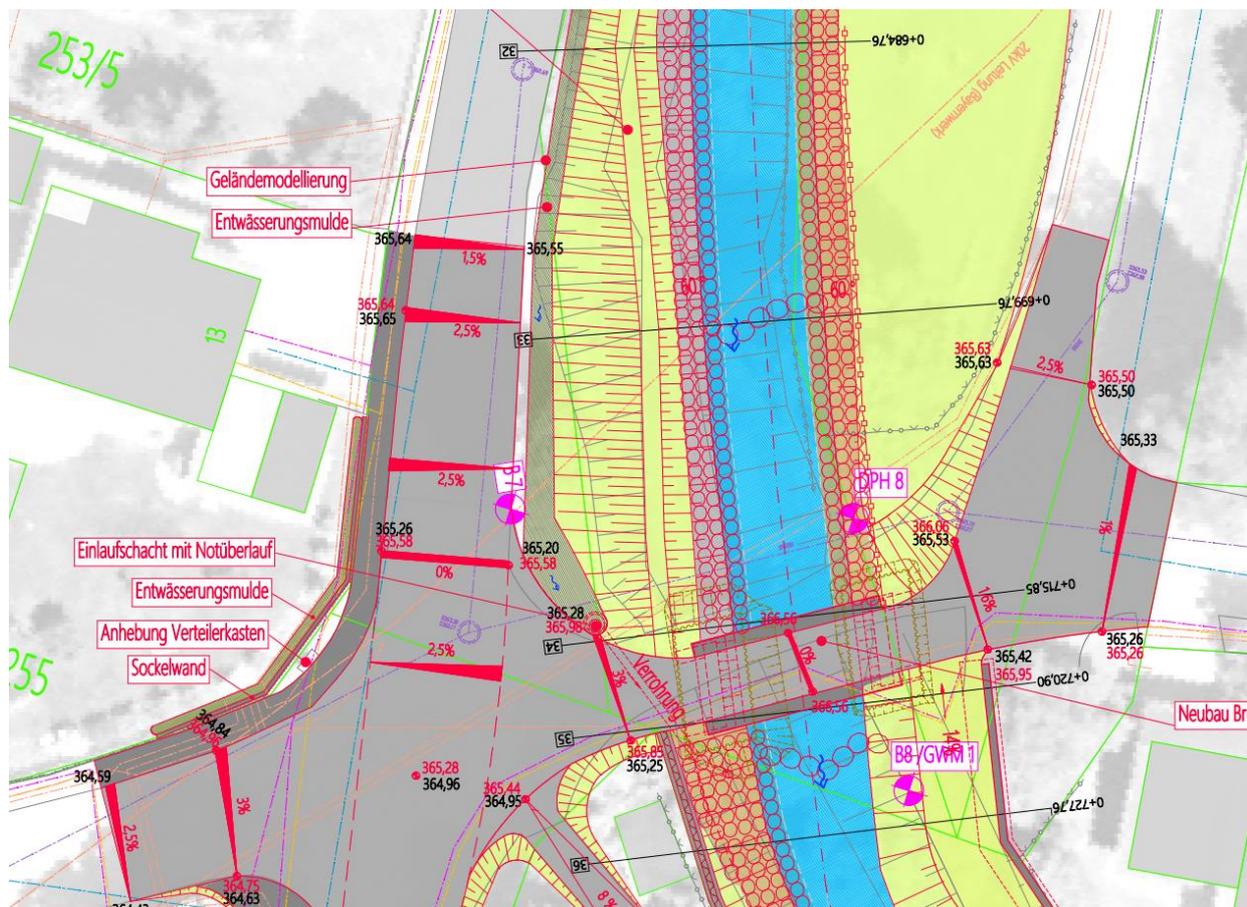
Auszug Lageplan Entwässerungsmulde Bahnhofstraße
